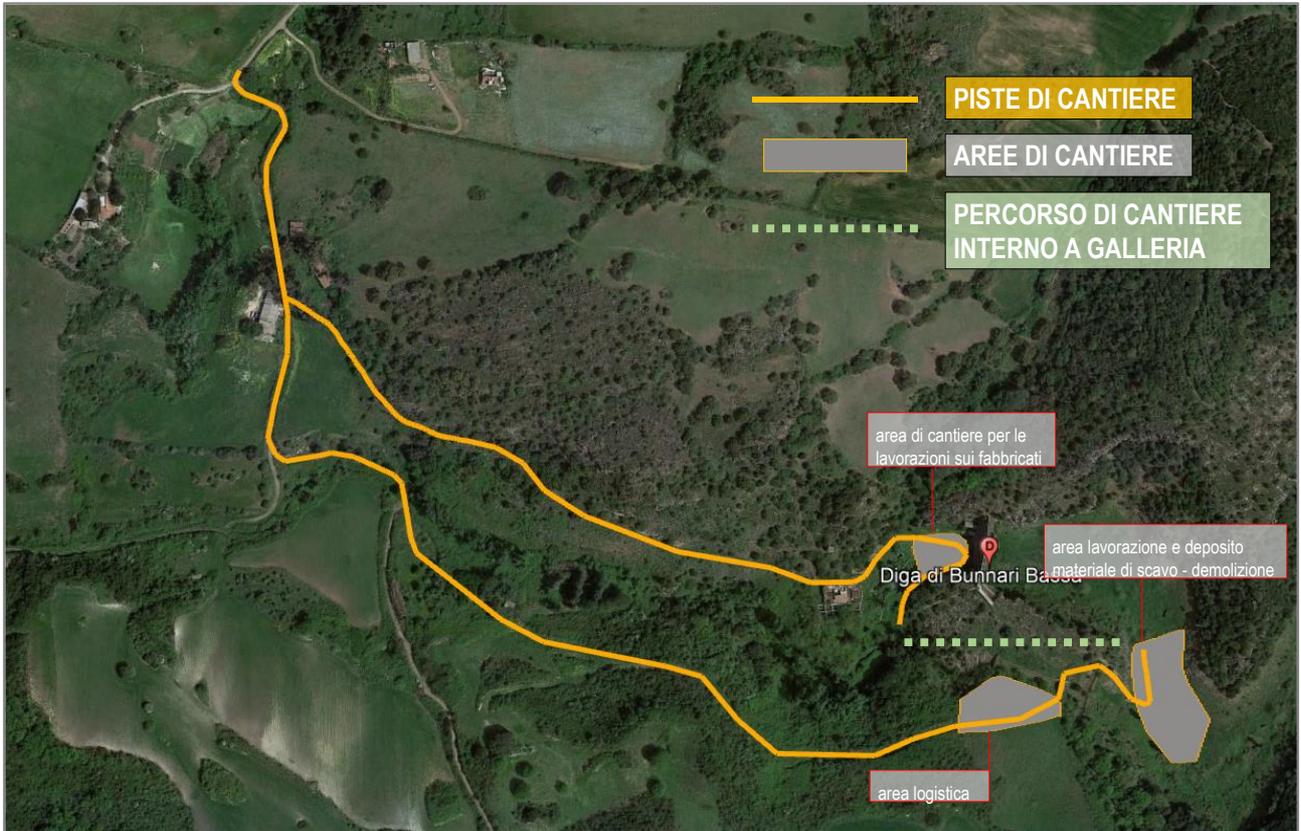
Stralcio planimetrico con indicazione degli apprestamenti di cantiere
